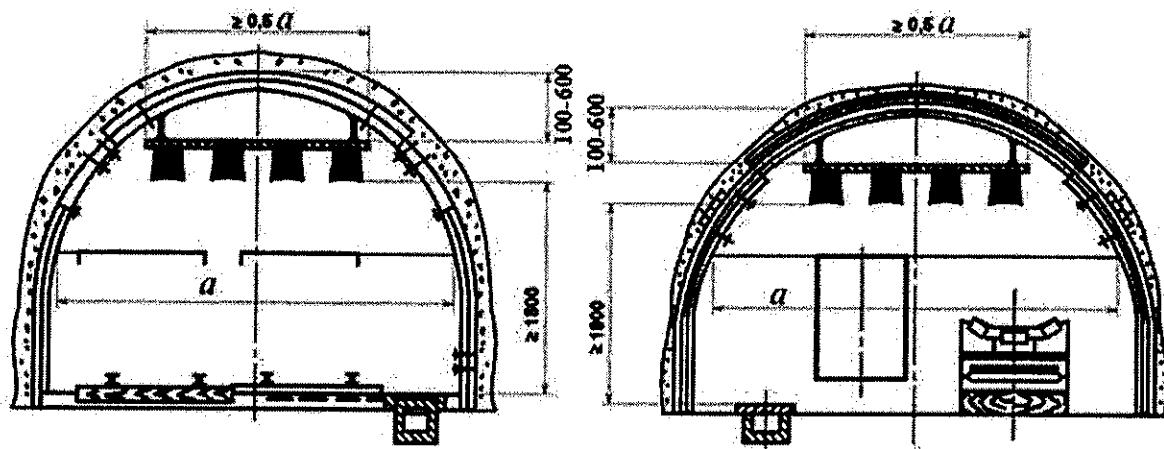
Рекомендуемая схема установки водяных заслонов из водяных карманов под кровлей выработки
